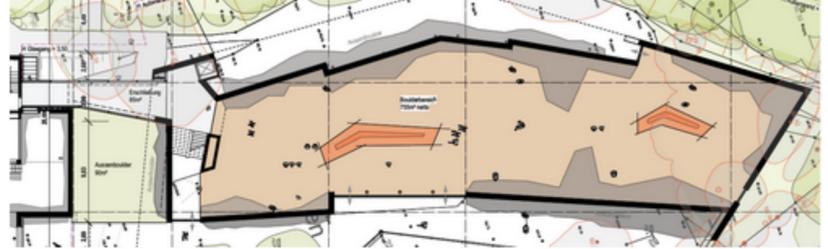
Grundriss Großinstandsetzung Erdgeschoss, Ebene des Eingangsbereichs, Boulderebene 02
